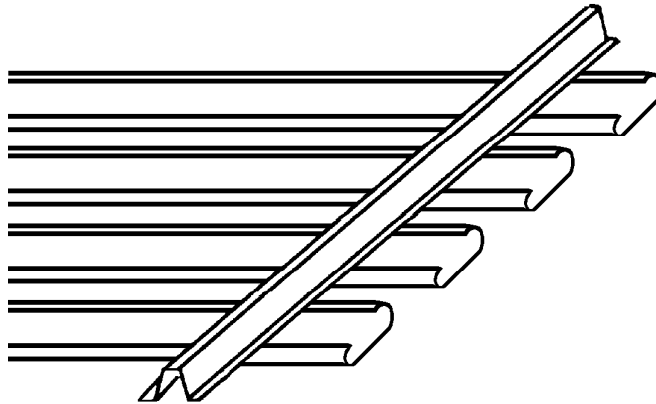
Beispiel für ein Paneel-Unterdeckensystem (weitere Ausführungen sind möglich)
